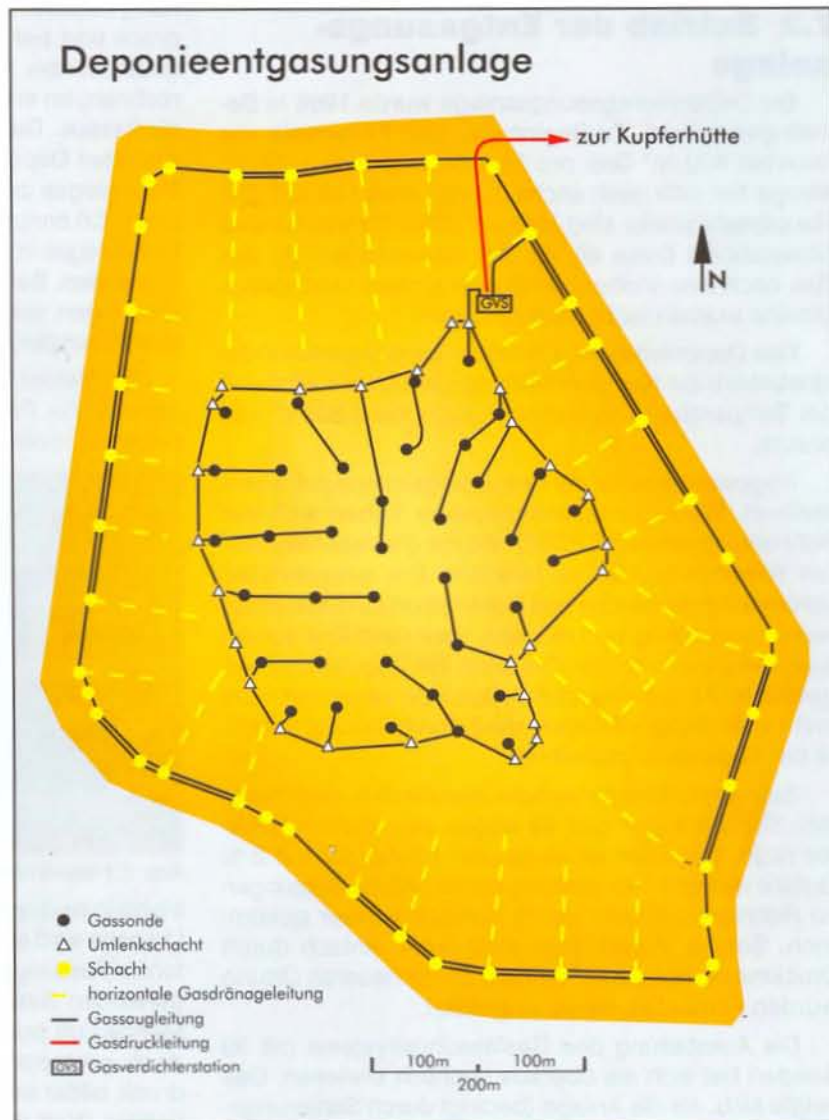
Lageplan der Deponieentgasungsanlage
